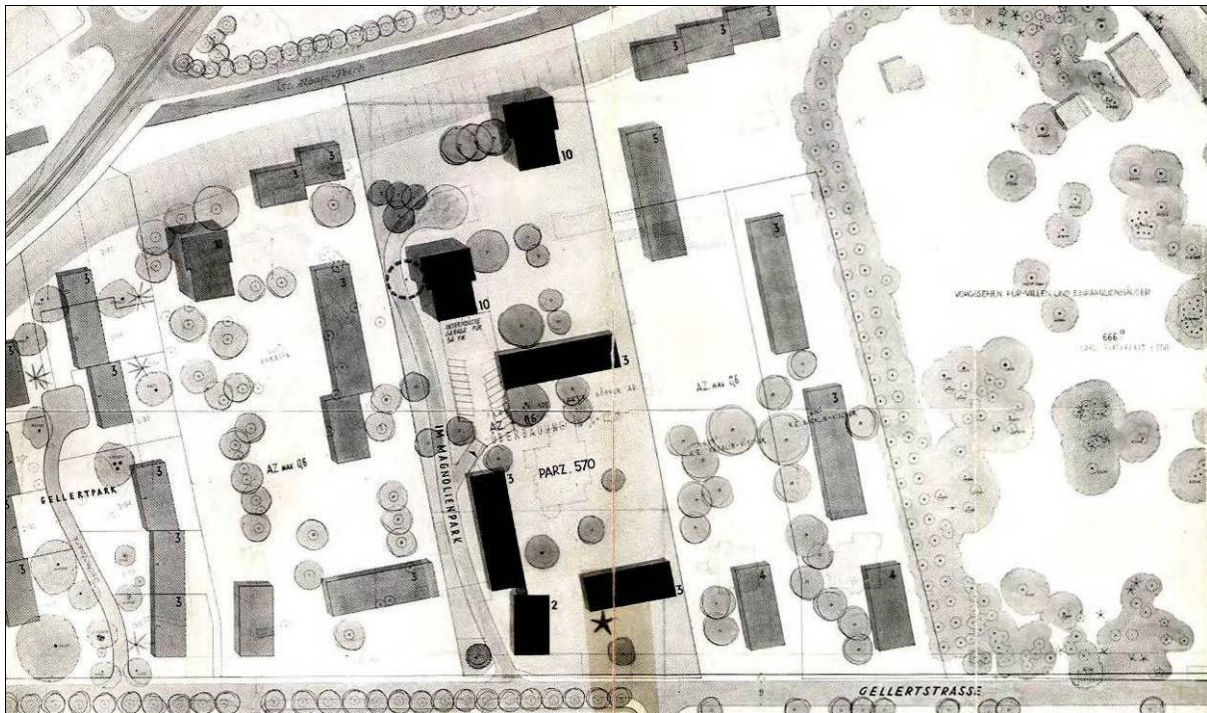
Bebauungsplan Nr. 60 aus dem Jahr 1955. (Ohne Massstab, Plan nicht genordet)
